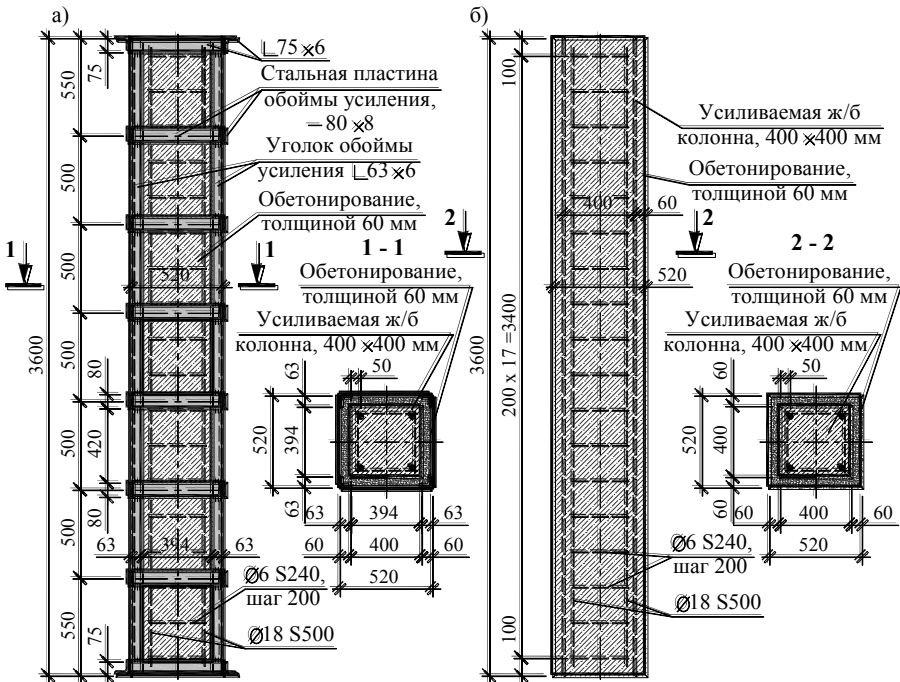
Конструкции моделей усиленных железобетонных колонн: а – модель железобетонной колонны, усиленной стальной облойкой с обетонированием; б – модель железобетонной колонны, усиленной только обетонированием
